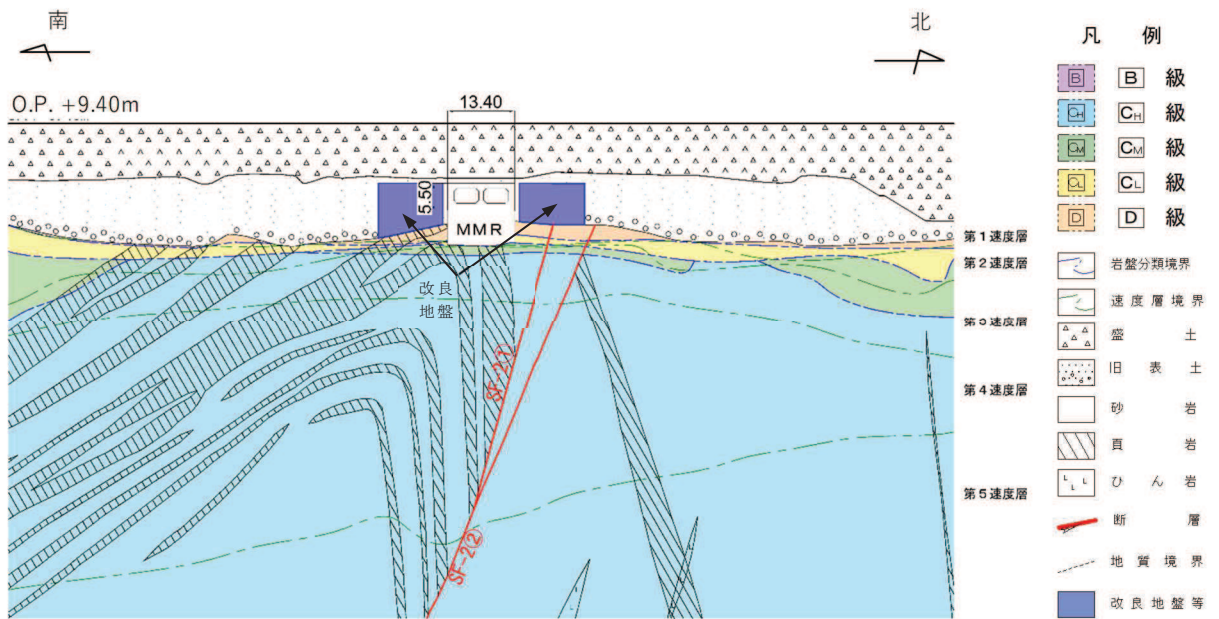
(2) 取水路の地質断面図 (㉔-㉔断面)
